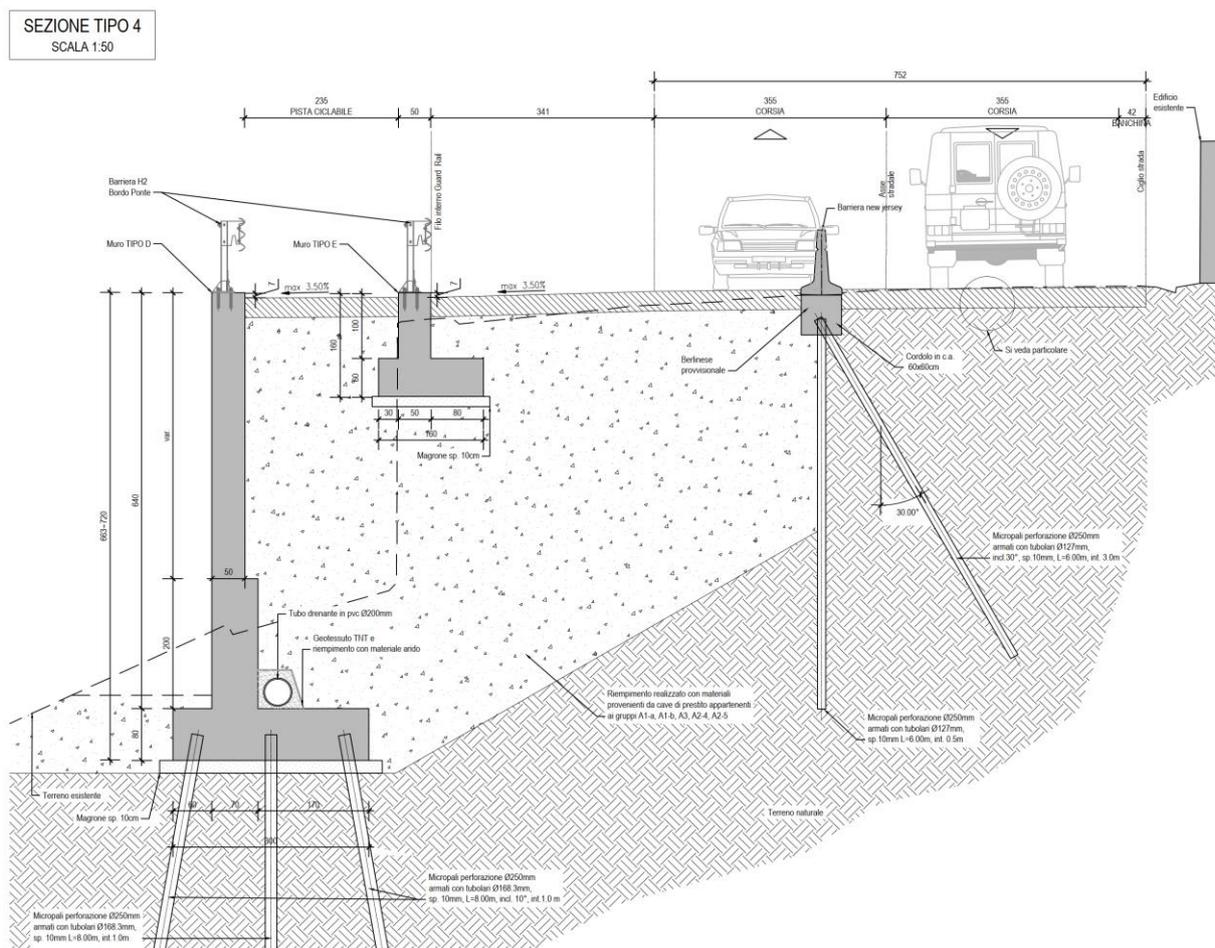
Sezione tipo 4 con muro di contenimento e adeguamento viabilità secondaria
